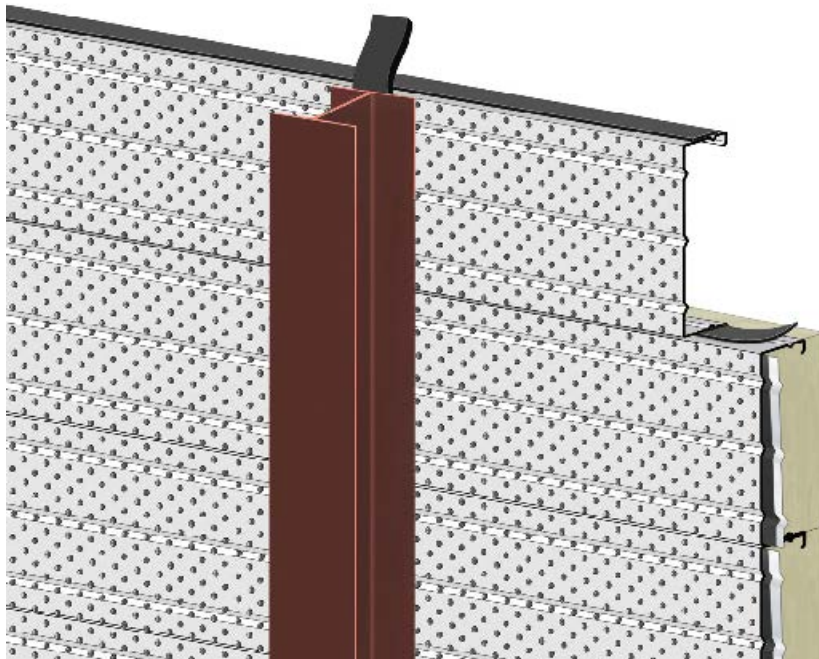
ter – Mise en place du joint d'étanchéité SUPER ETANCOPLAST sur plateaux métalliques perforés
